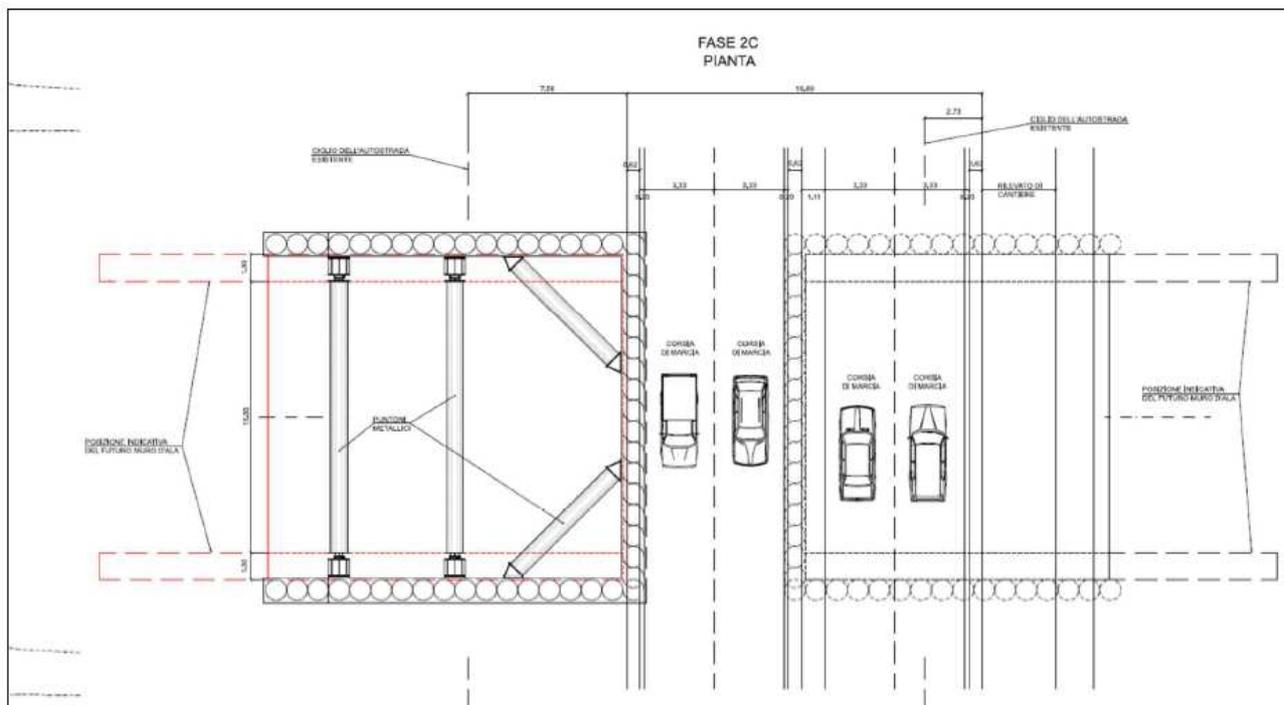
Sottovia A14 – Fase 2C (pianta)
